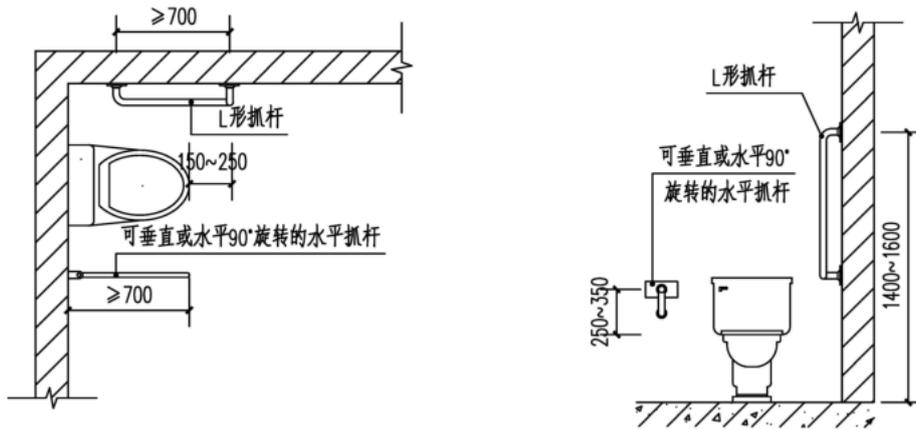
坐便器安全抓杆设置平面图 图 7.4.6-2 坐便器安全抓杆设置正立面图
